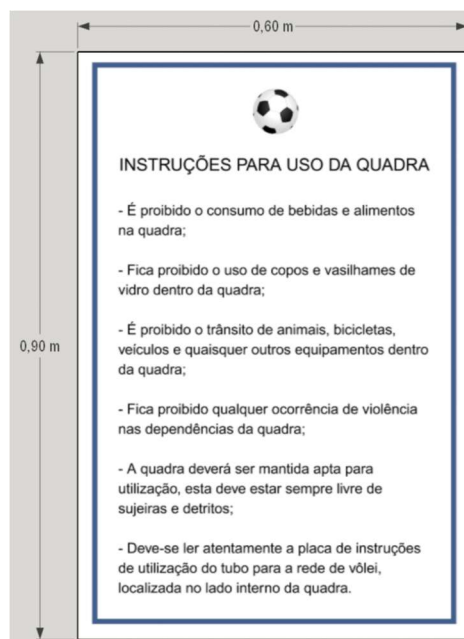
Detalhe Ilustrativo de placa de instruções (Fonte: Autor/2026)
